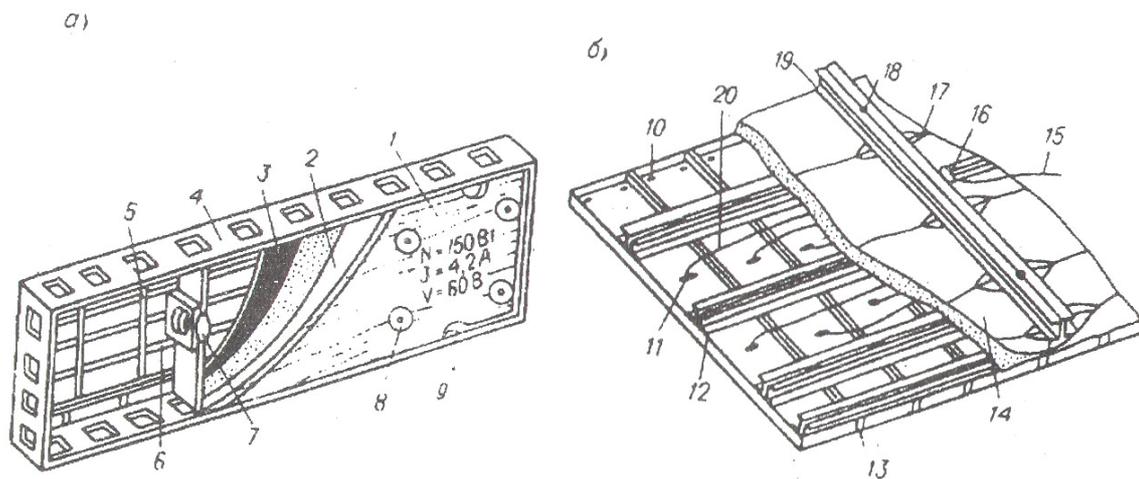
Термоактивная опалубка: а — щит; б — крупноразмерная панель; 1 — фанерная крышка; 2 — утеплитель; 3 — экран из фольги; 4 — ребро каркаса; 5 — кляммеры; 6 — греющий кабель; 7 — вилка инвентарного разъема; 8 — вырез; 9 — вырез для установления монтажного крюка; 10 — термоактивный щит; 11 — инвентарный разъем; 12 — схватка; 13 — натяжной крюк; 14 — шлаковойлочное одеяло; 15 — клеммная коробка; 16 — кабель; 17 — отверстие; 18 — Т-образный болт; 19 — связь; 20 — коммутирующий кабель
